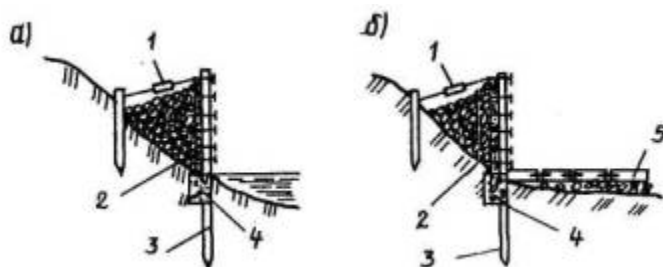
Продольные откосоукрепительные железобетонные ограждения:
